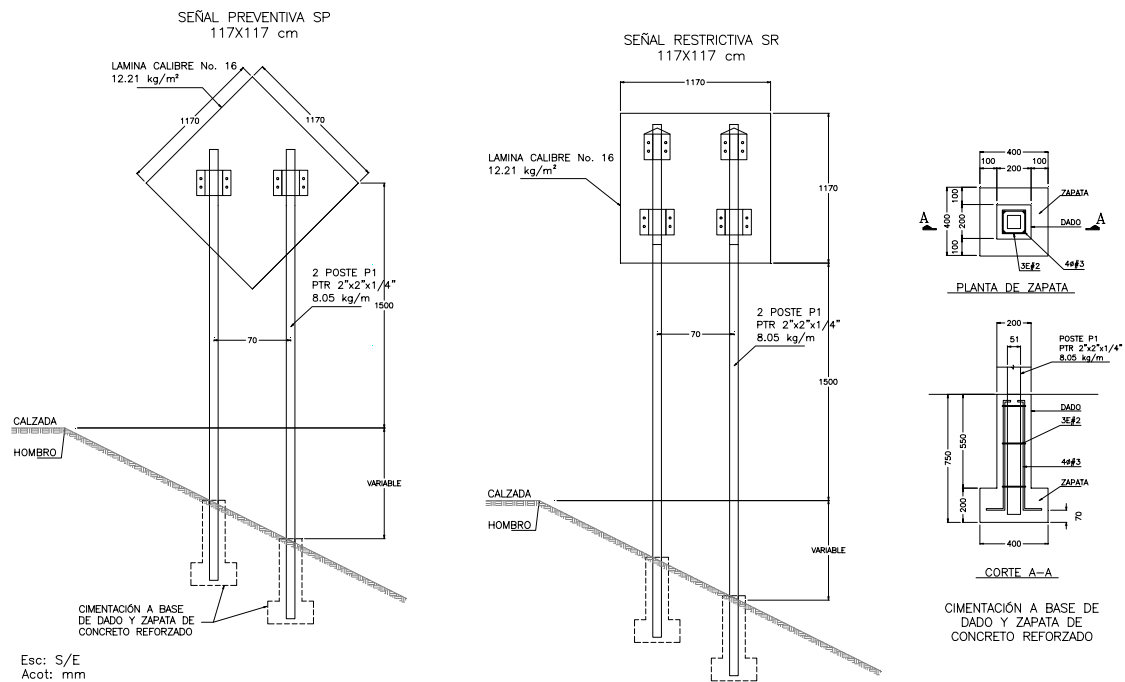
Detalle de la estructura de soporte y cimentación de las señales preventivas SP y restrictivas SR.
